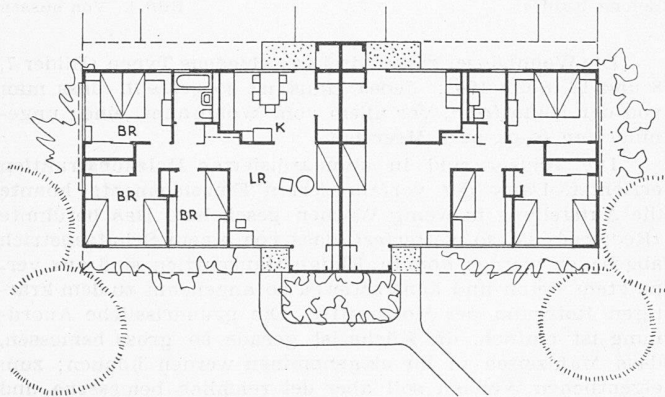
Einstöckiges Vierzimmer-Doppelhaus
